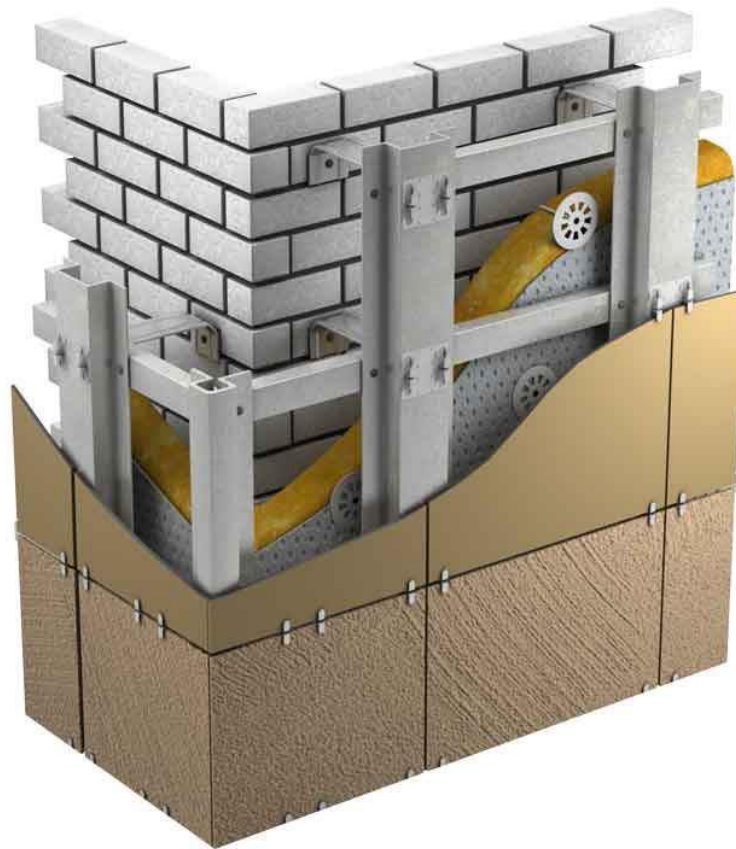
9. Конструкції систем вентиляваного фасаду
